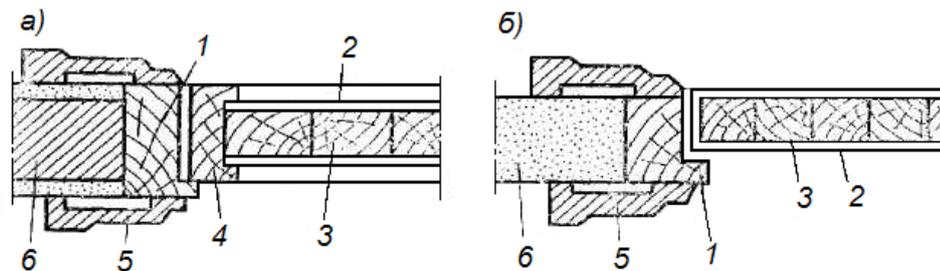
Конструкции дверных полотен зданий: а – щитовое полотно с обкладками; б – то же, без обкладок; 1 – коробка; 2 – листовая фанера; 3 – столярная плита; 4 – обкладка; 5 – наличник; 6 – перегородка
